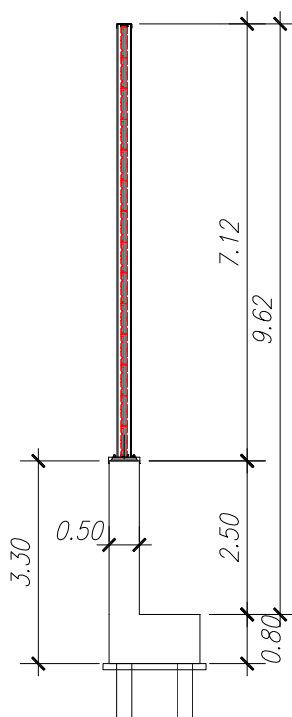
Sezione tipo barriera antirumore ML10 su rilevato
